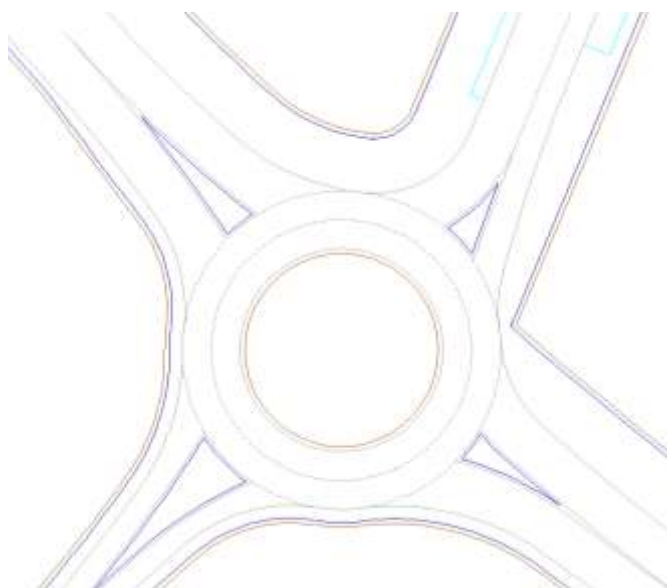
Diseño en planta de la glorieta de nueva construcción
